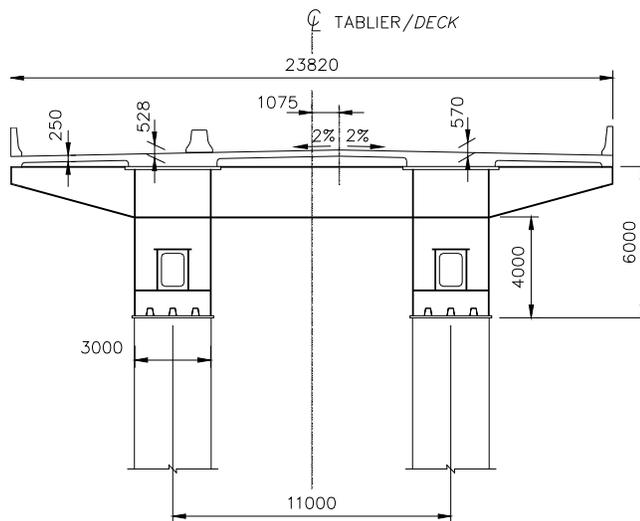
Coupe transversale – Pont en ossature mixte avec des piles en V – monocaïsson ouvert
